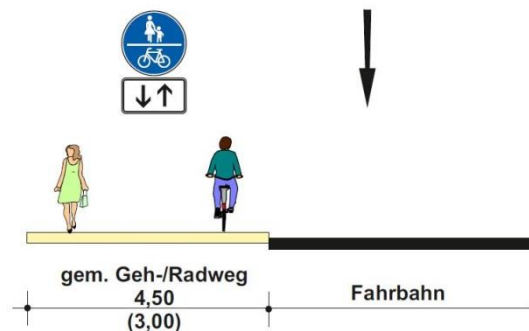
Querschnitt für den Ausnahmefall einer Premiumroute mit straßenbegleitendem gemeinsamen Geh- und Radweg, Radverkehr im Zweirichtungsbetrieb
